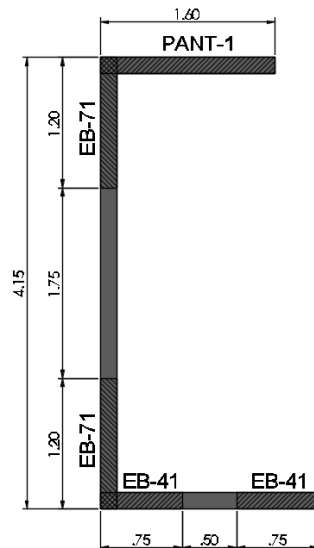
Sección en planta esquemática muro M-2. Fuente: Elaboración propia.
